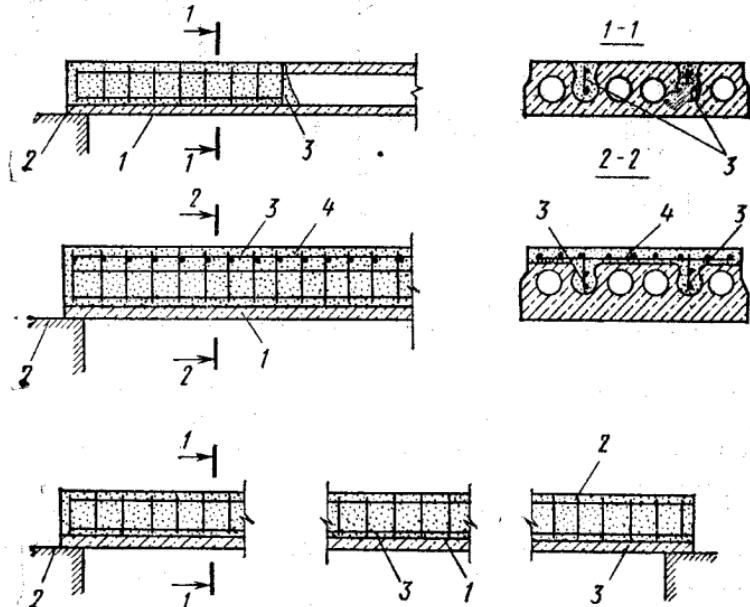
Усиление сборных многопустотных плит перекрытия:
